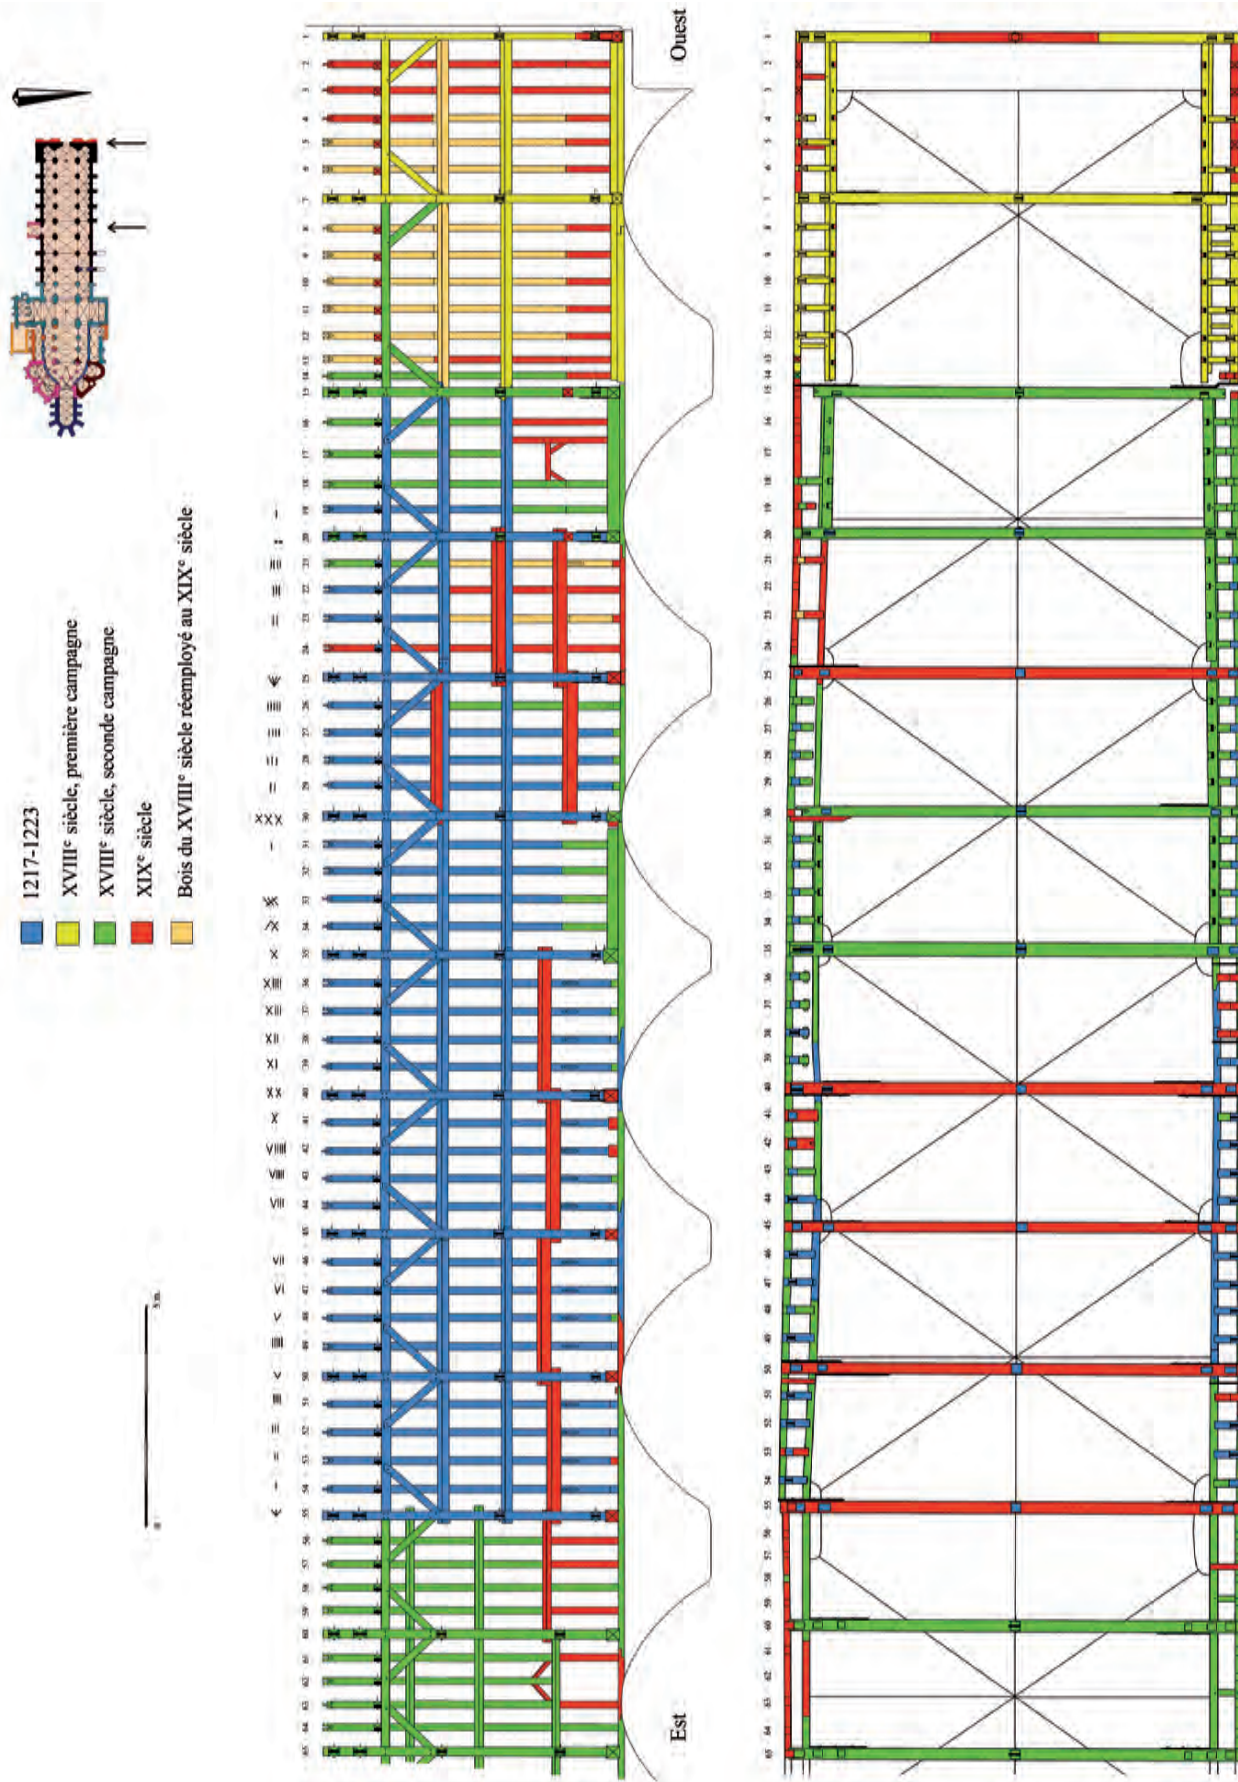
Coupe longitudinale vue du nord (en haut), et plan de la charpente de la nef (en bas).
